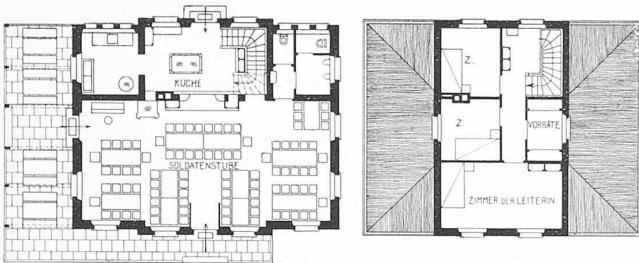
Grundriss vom Erdgeschoss und 1. Stock. — Masstab 1 : 300.
